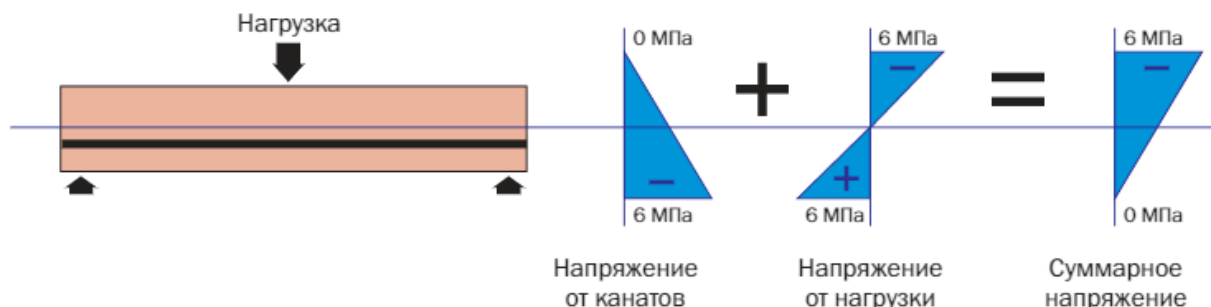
Принцип предварительного напряжения железобетонных конструкций [5]
